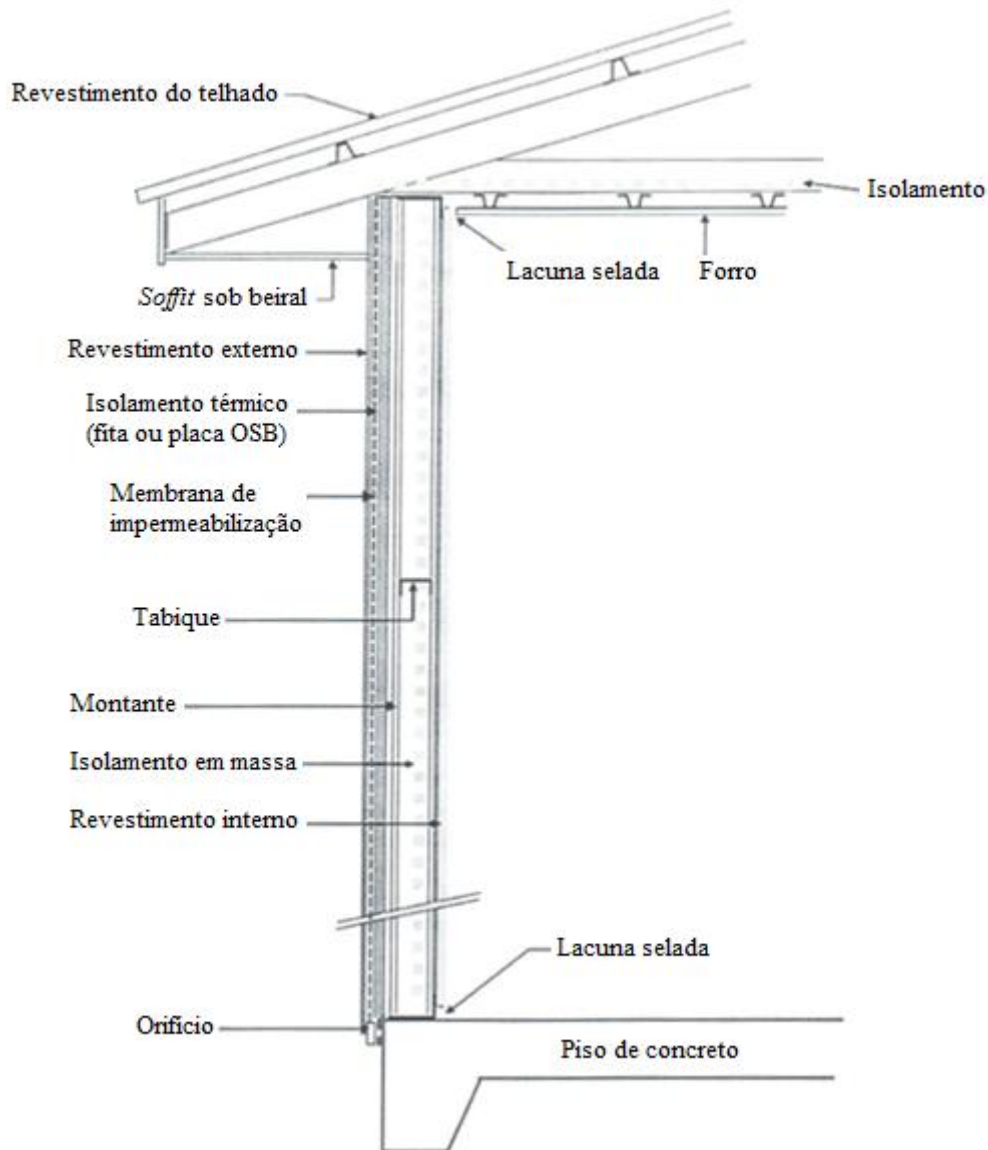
47- Seção transversal típica de uma fachada em *steel frame* (SANS, 2009)
